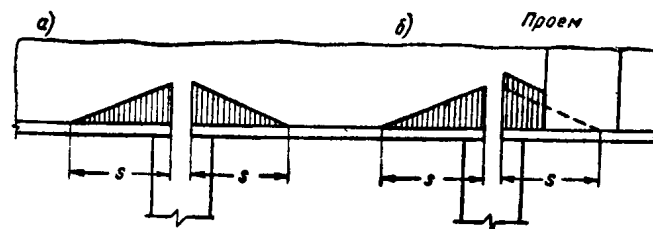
Эпюра распределения давления в кладке висячих стен, поддерживаемых однопролетными рандбалками
